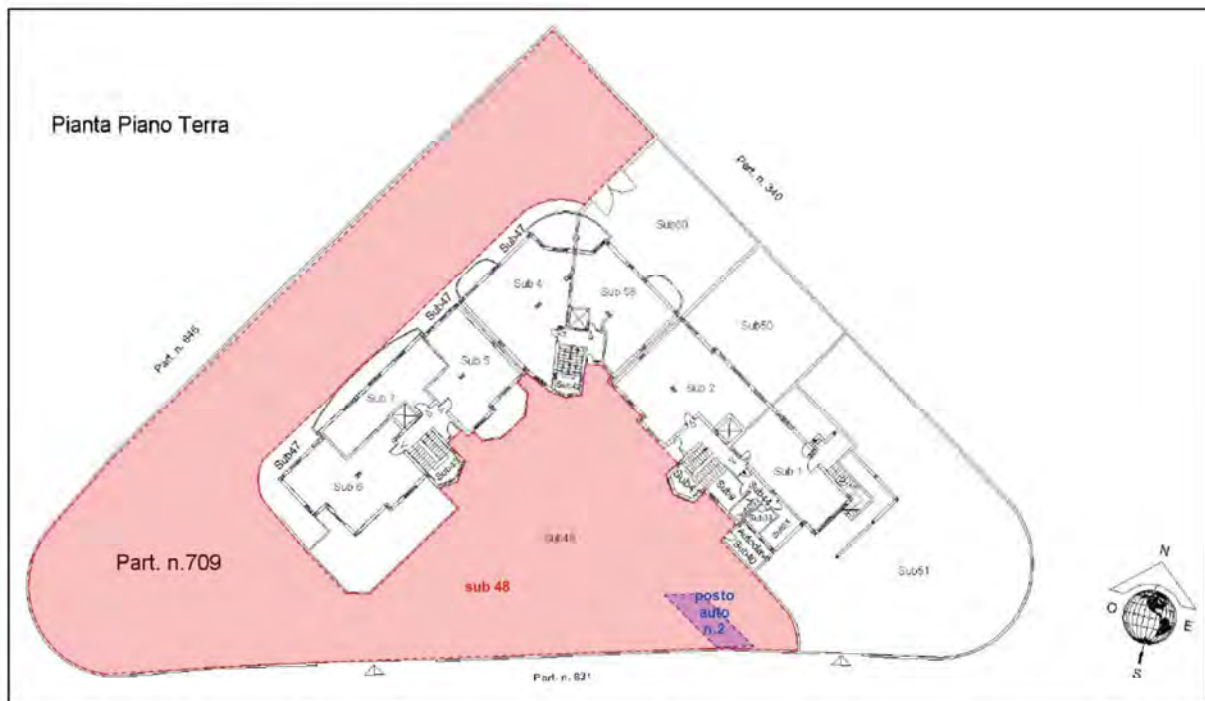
Individuazione indicativa del posto auto collegato all'appartamento pignorato all'interno dell'elaborato planimetrico del piano terra (foglio 74 particella 709 sub 48)
